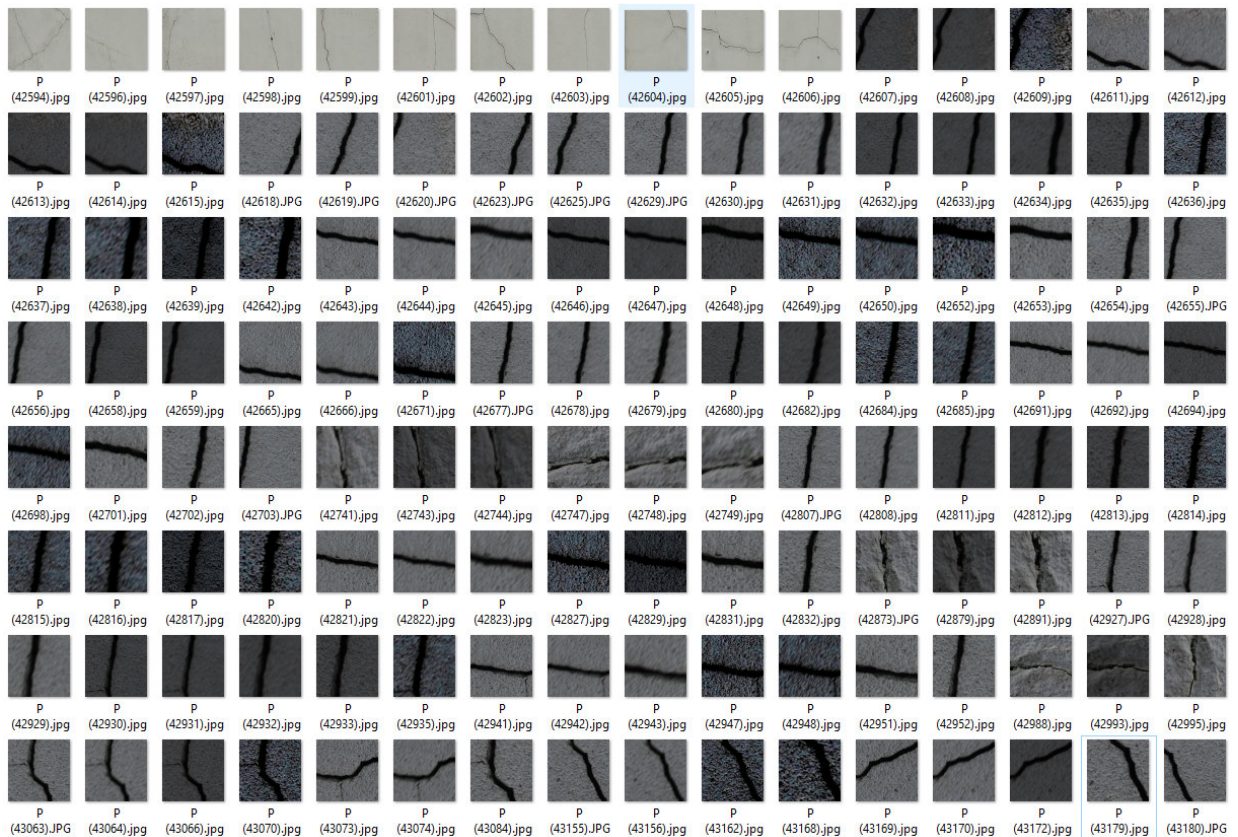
Amostra das imagens com fissuras da rede 4
